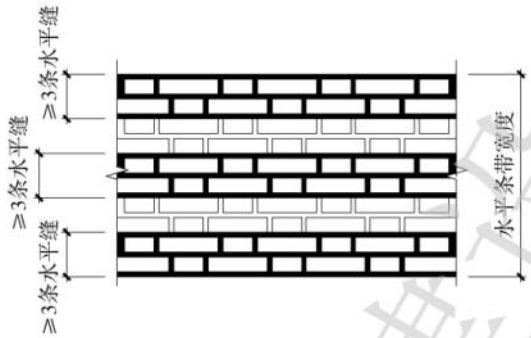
高延性混凝土水平条带嵌缝示意图
